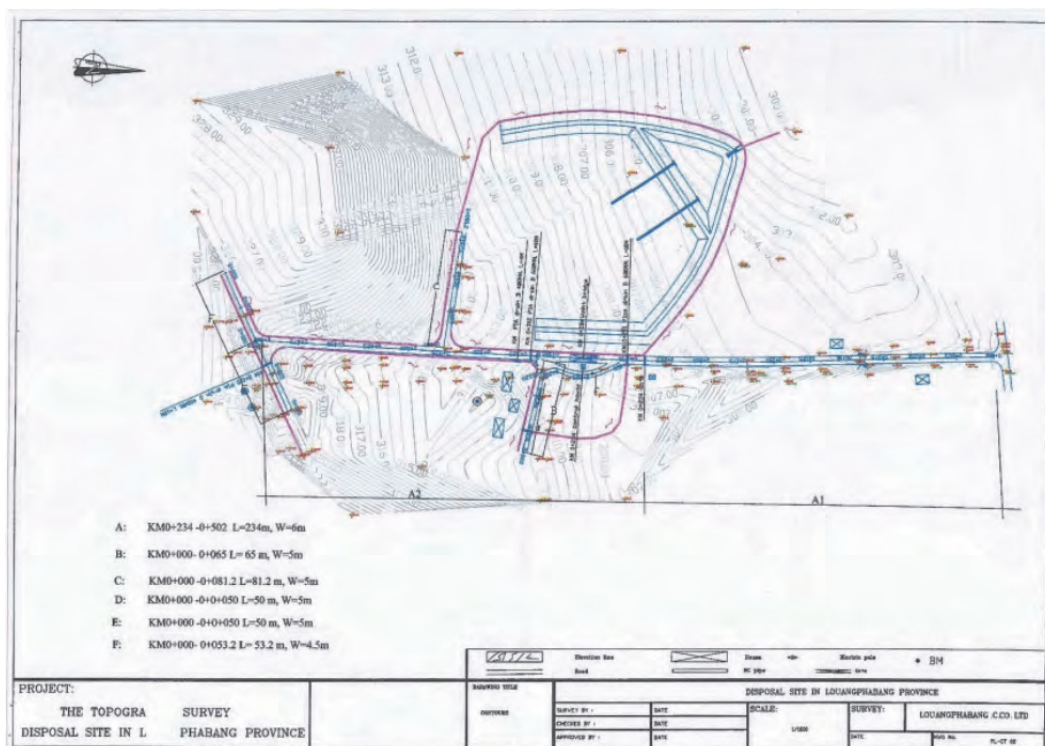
既存 KM8 最終処分場改善の竣工平面図
